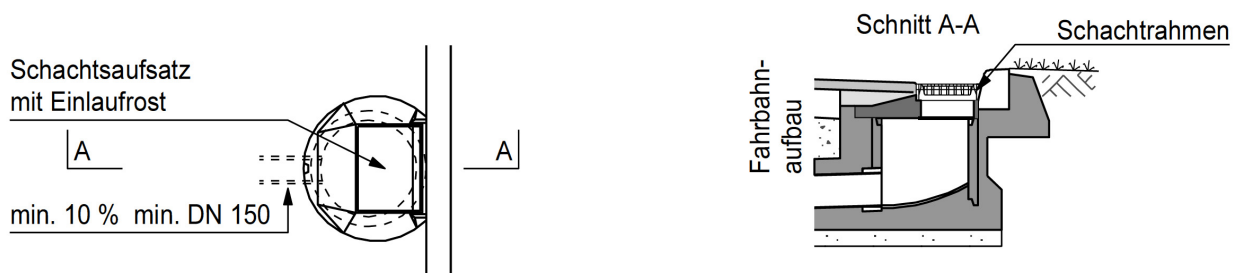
Grundriss, Schnitt Einlaufschacht
